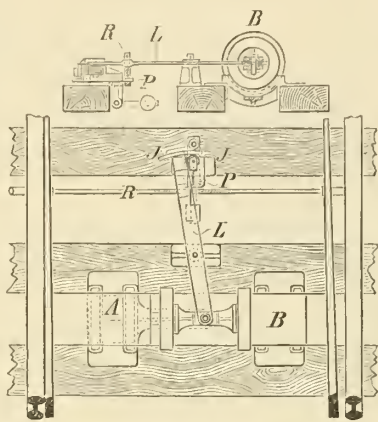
u. 6. Aufsicht und Grundriss.
